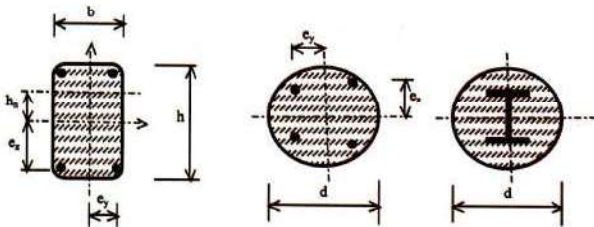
Exemple des sections transversales des poteaux en tube rempli de béton.
